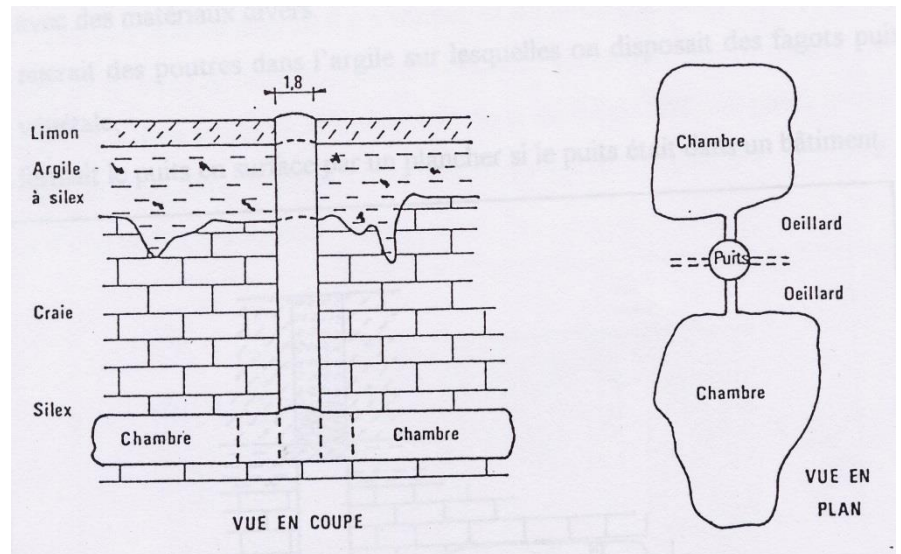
Vues en coupe et en plan d'une marnière (source ALISE)
